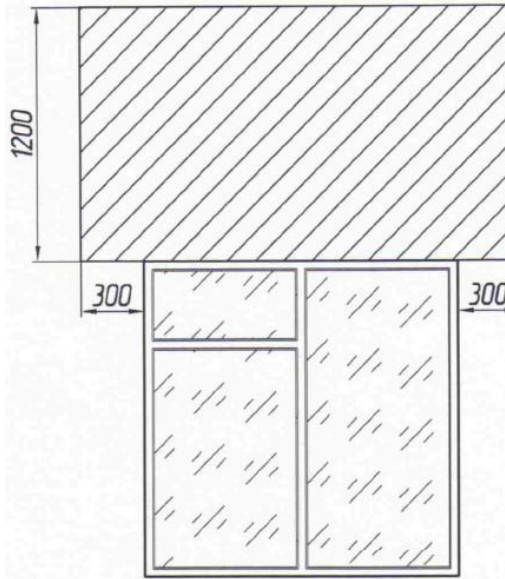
участки фасада с особыми требованиями к монтажу системы по пожарной безопасности.
